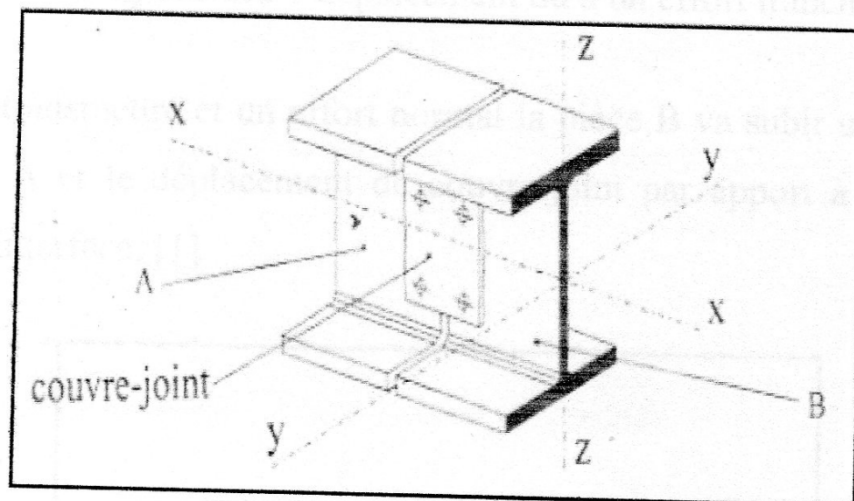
Assemblage de deux pièces A et B avec couvre-joint
